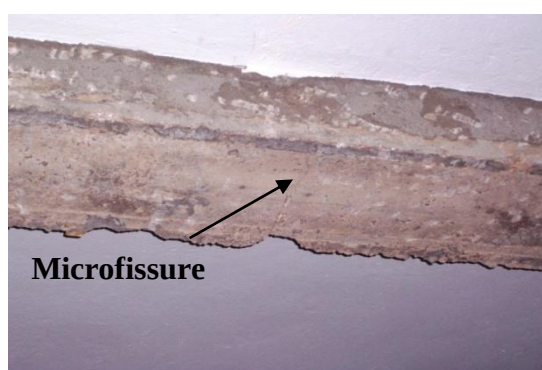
Apparition des microfissures au niveau de la poutre
